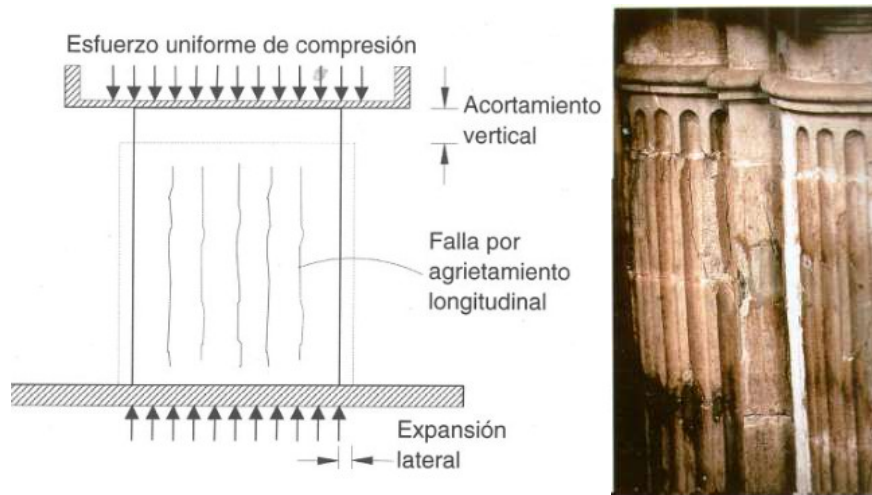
Daño típico en columnas con agrietamientos verticales cuando se alcanza su capacidad a compresión. Ejemplo de esta falla en una columna de la Catedral Metropolitana (Meli R., 1998).
